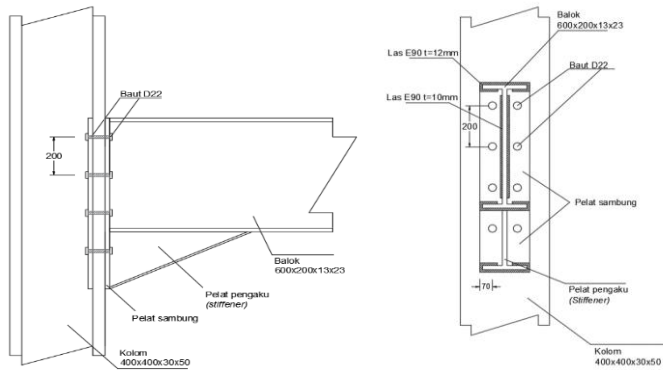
Tampak Depan dan Tampak Samping pada Sambungan Balok-Balok
